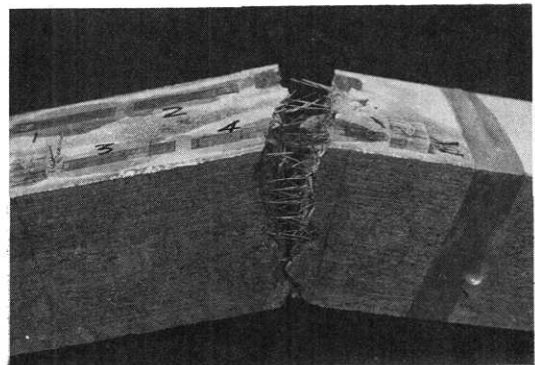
鋼繊維補強コンクリートの曲げ破壊後の状況
